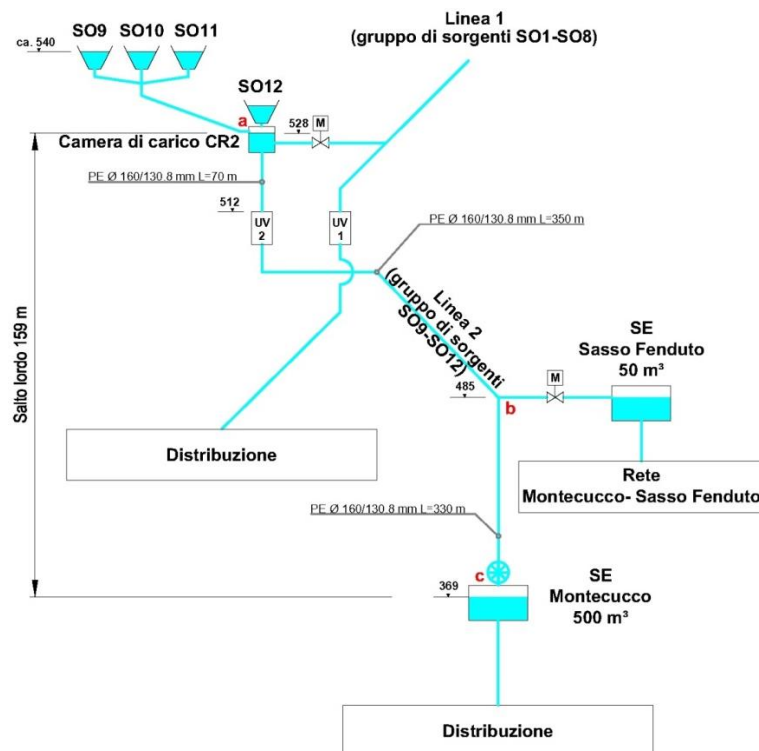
Schema idraulico rete di adduzione (stato finale)
